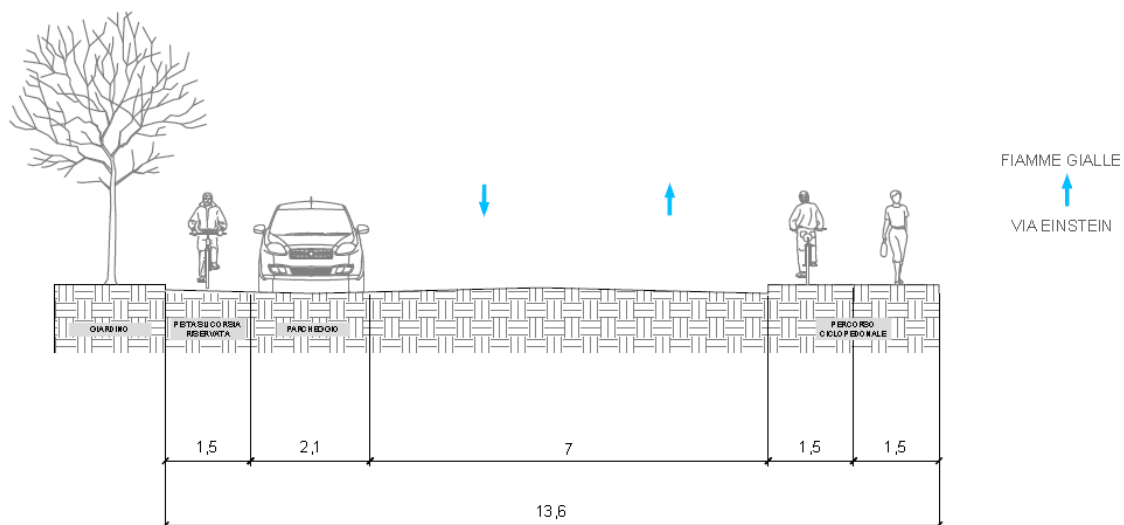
Sezione tipo Via Enrico Fermi – stato di progetto
